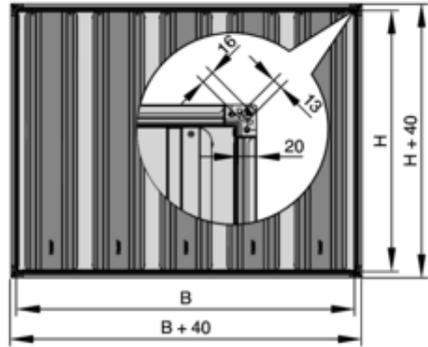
Silencieux à baffles avec profil de conduit d'air de 20 mm (T)
